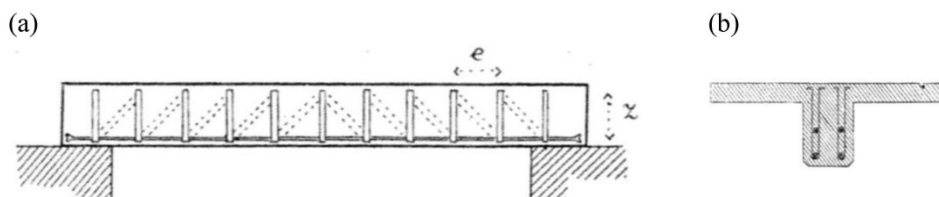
Fachwerkmodell von Ritter zur Bemessung der Querkraftbewehrung (aus [Ritter 1899]): (a) Fachwerkmodell eines einfachen Stahlbetonbalkens und (b) Querschnitt durch Rippendeckenunterzug mit Biege- und Querkraftbewehrung.
